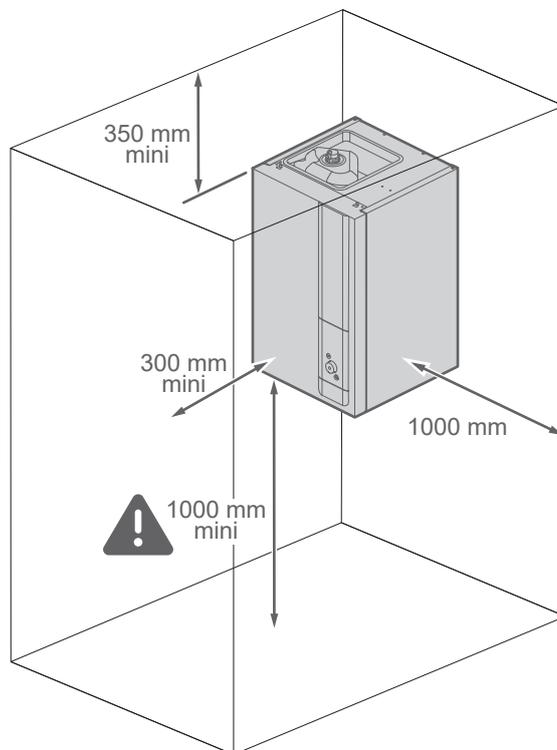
Dégage minimum d'installation autour du module hydraulique pour l'entretien
